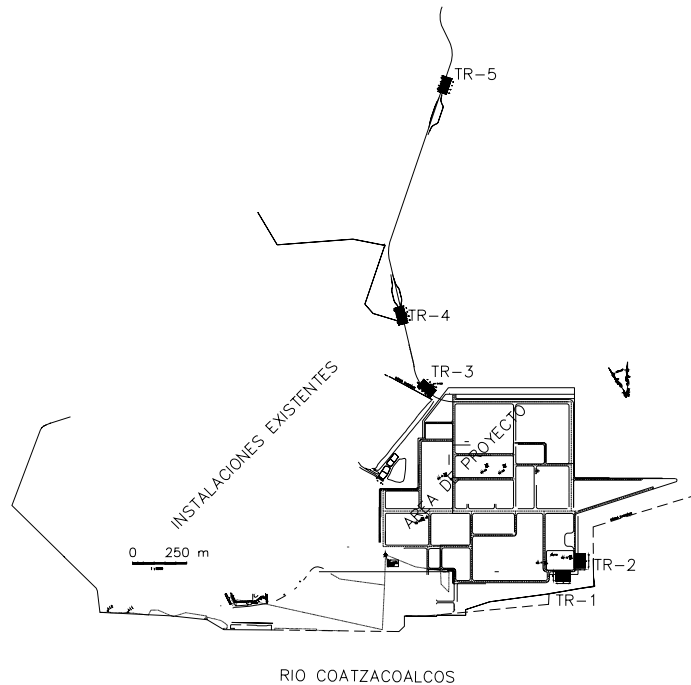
Croquis con la ubicación de los terraplenes de prueba.
